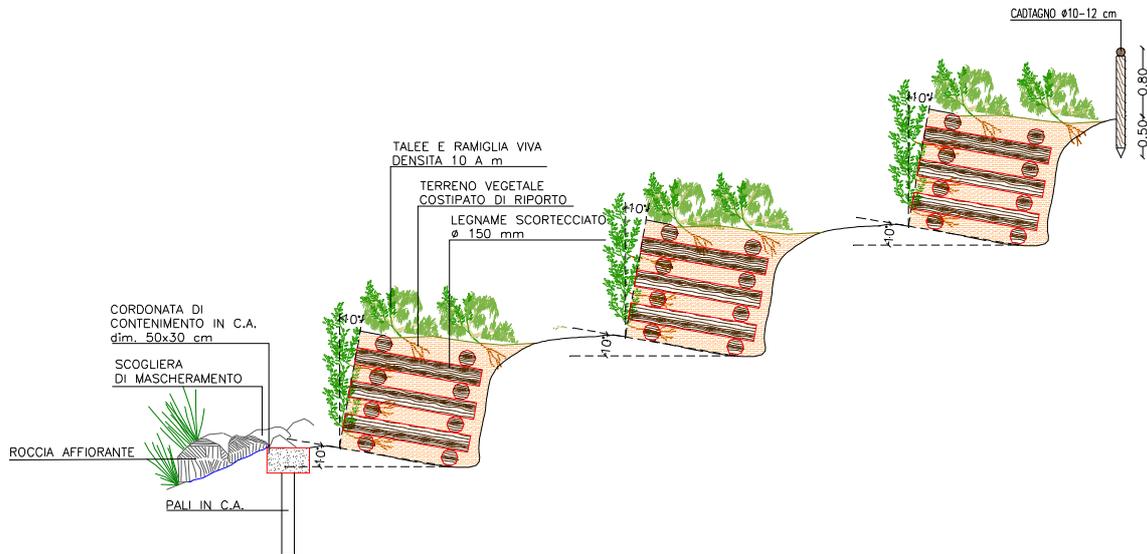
sezione trasversale delle opere di consolidamento (palificata rinverdita)
